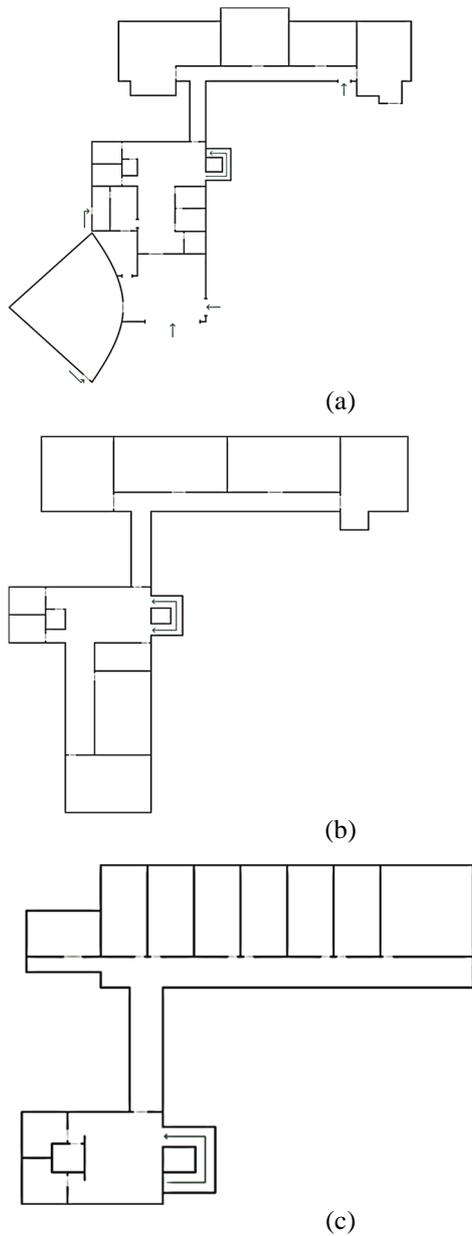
Planta baixa do CEAMAZON com (a) Térreo, (b) 1º andar, e (c) 2º Andar.
